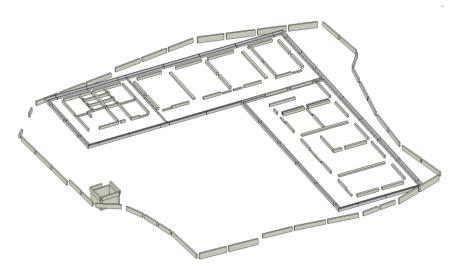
Categoría Muros aislada del modelo federado de Estructuras
